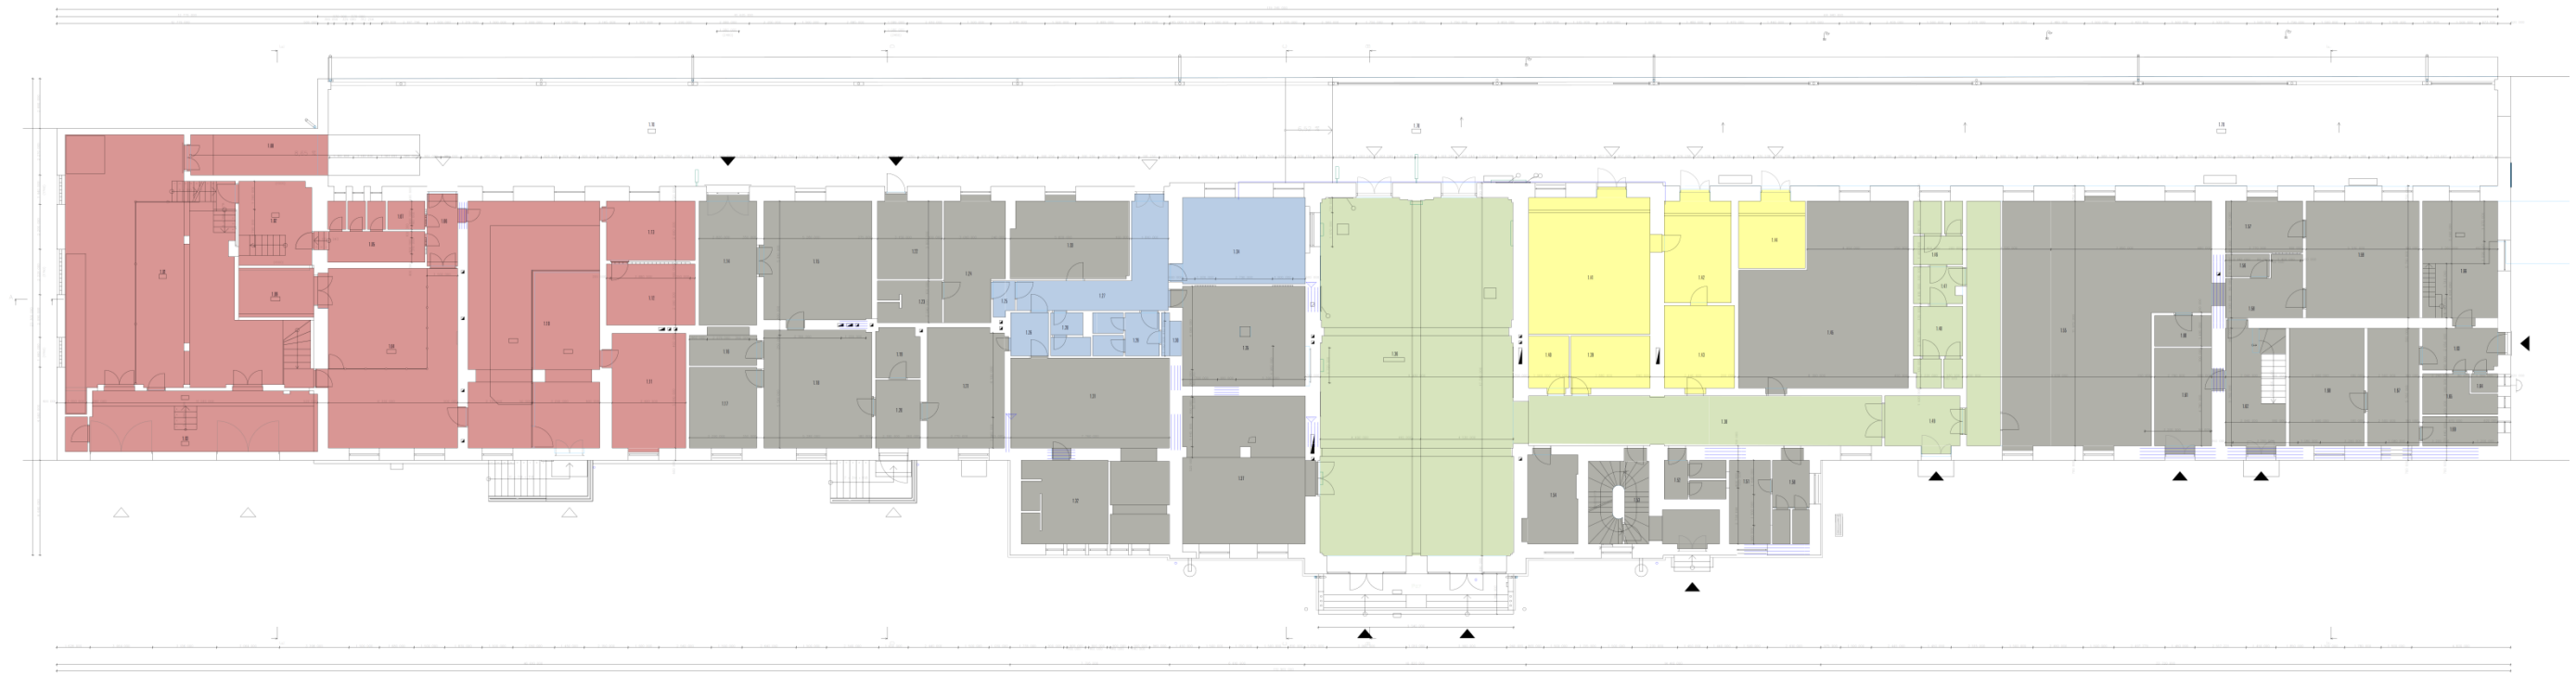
Půdorys 1. PP – stávající stav s barevným vyznačením využití jednotlivých prostor
